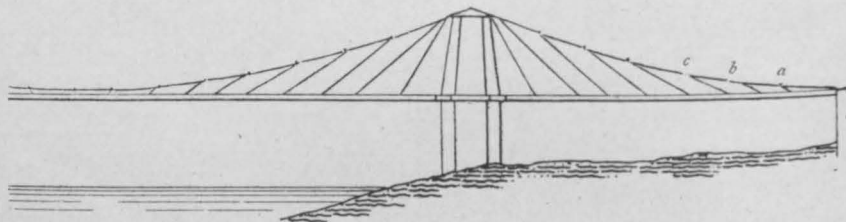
Kettenbrücke der Bauart DREDGE, 1840.
